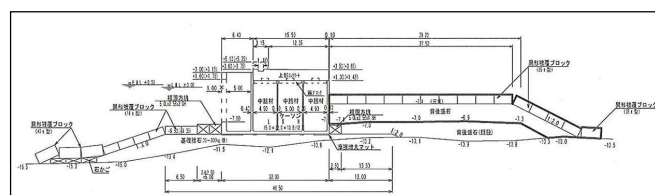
(2) 雄冬漁港 島防波堤および背後小段傾斜堤断面図
